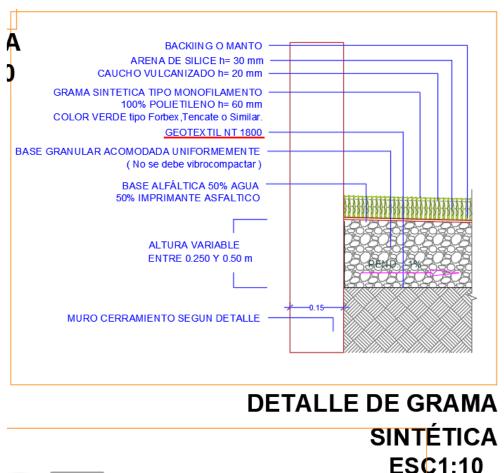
Pantallazo detalle de grama sintética. Planimetría Arquitectónica – Detalles arquitectónicos
